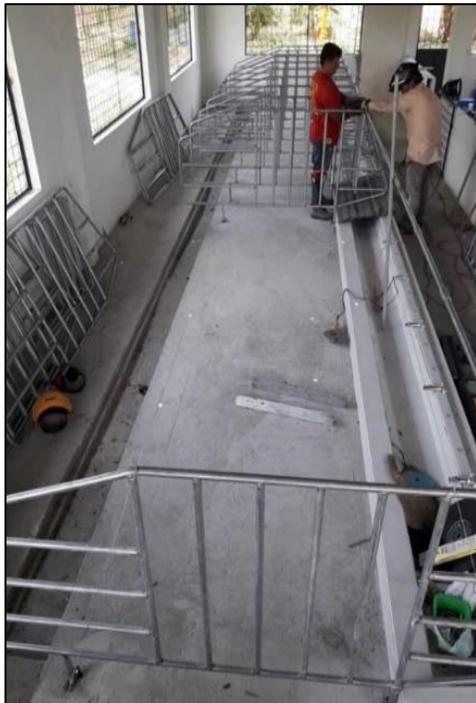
Ubicación de las paredes de las jaulas de gestación.
